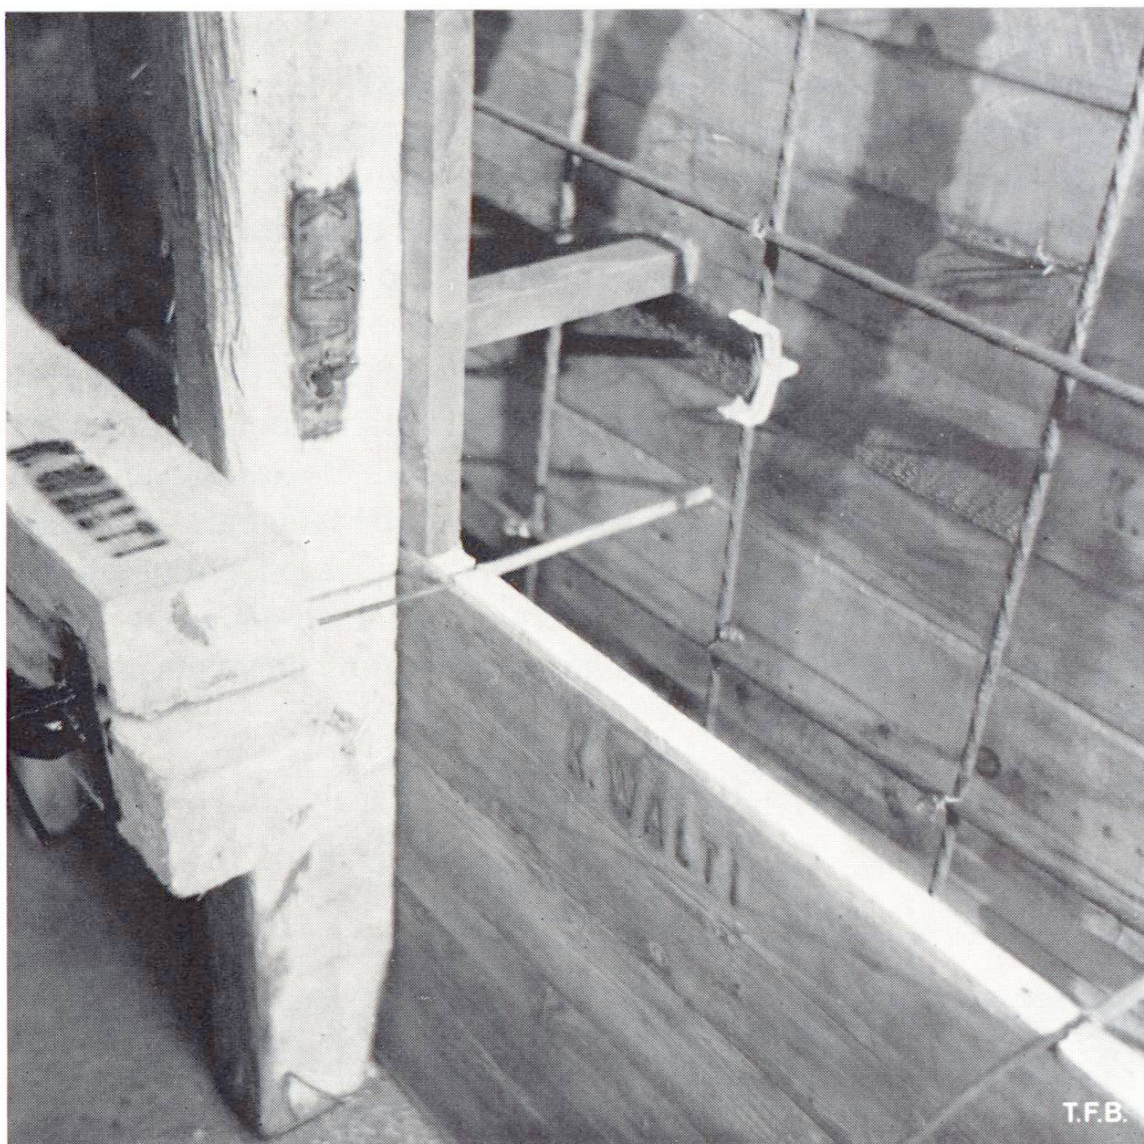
Montage du coffrage en panneaux d'un béton apparent. On remarquera un des fils de liaison passant dans un tube en plastique.
